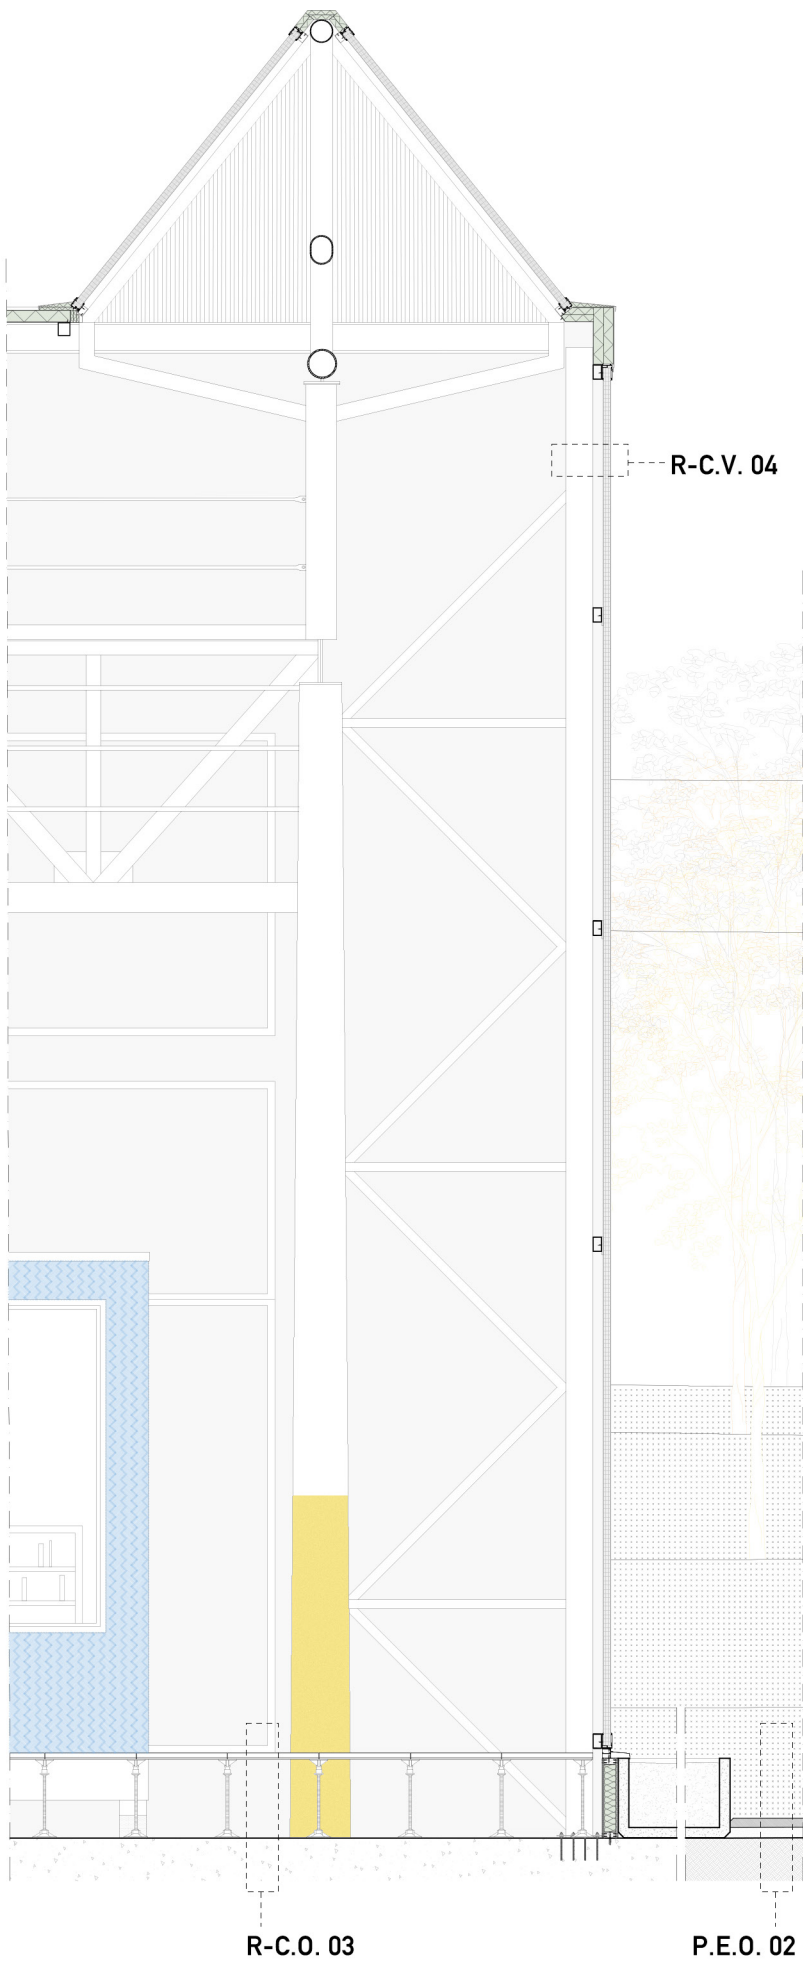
Tavola 62, Blow Up: prospetto est
